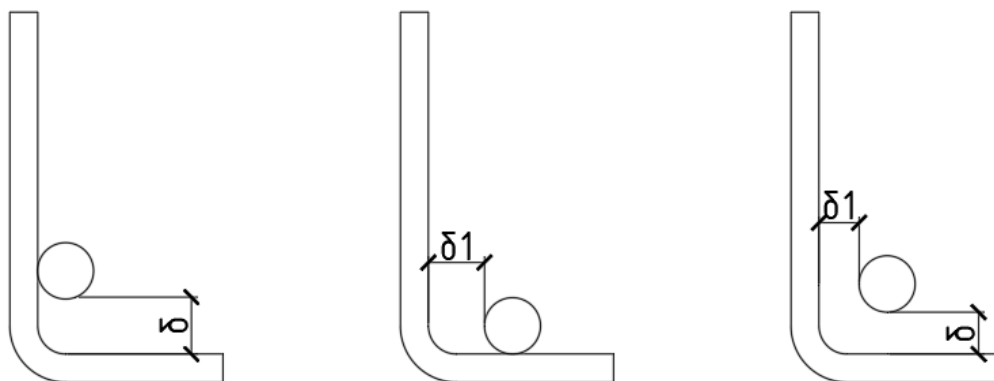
Допуски по отклонению расположения продольной арматуры в поперечных хомутах
